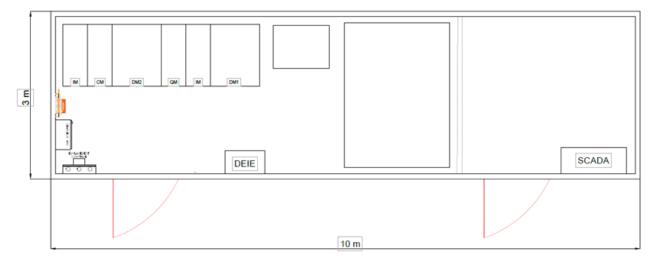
Exemple d'implantation d'un poste de livraison.
